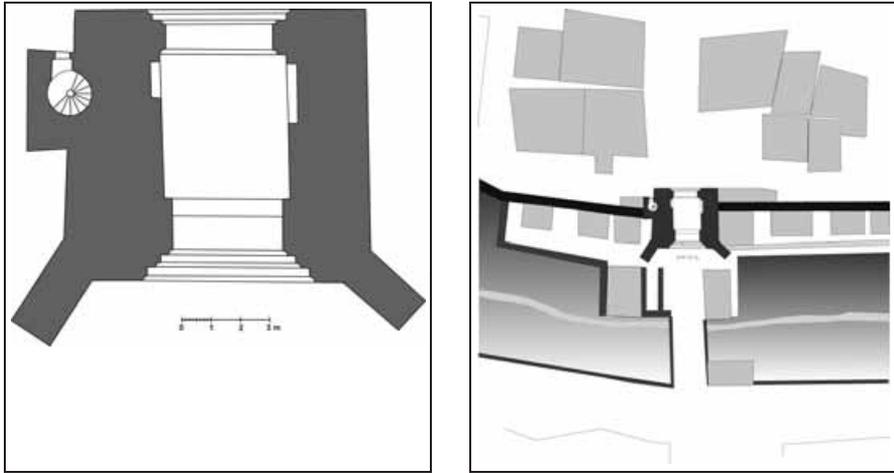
und 4b: Grundriss des Torturms und Einbindung in die Stadtbefestigung um 1820.
